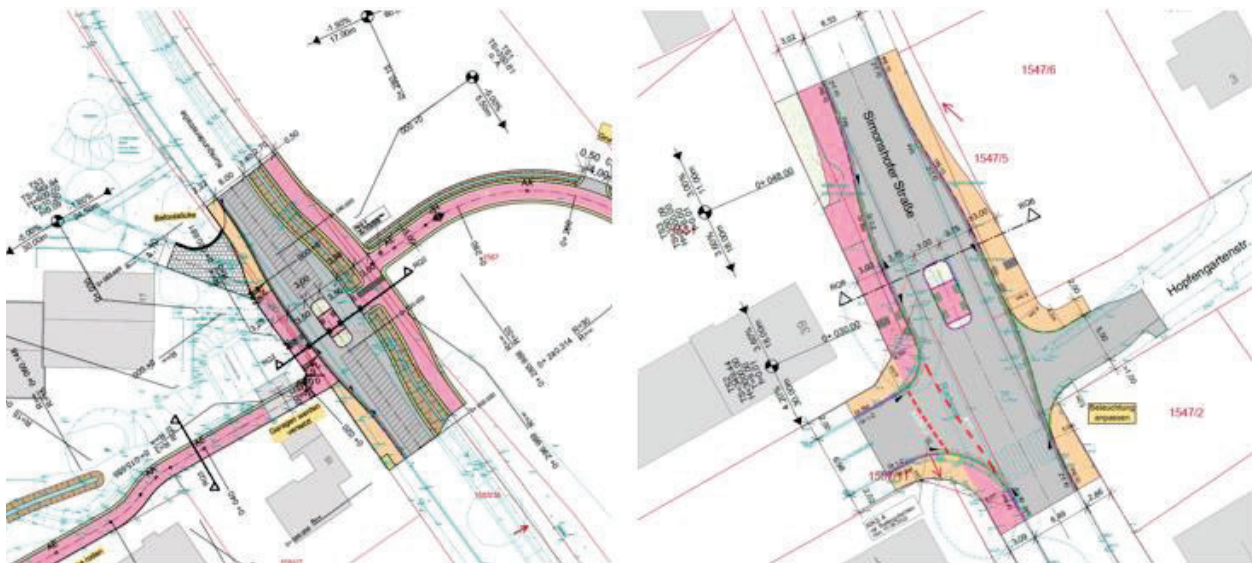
Ausschnitte der bisherigen Planunterlagen an den Querungen (Quelle: Stadt Lauf)
